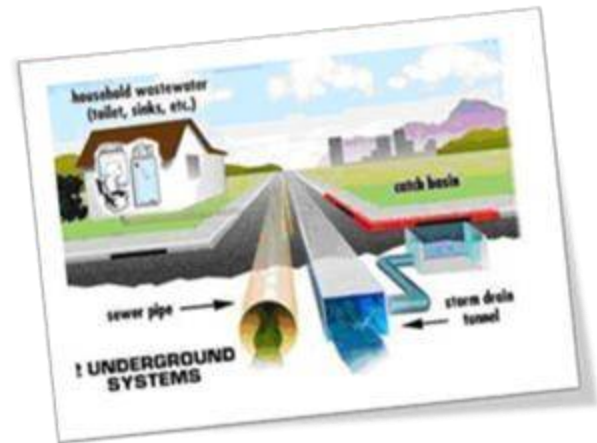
Imagen de la descripción del drenaje. Fuente: <http://ingenierocivilsen-ex.g.blogspot.mx/2009/06/drenaje-o-alcantarillado.html>
